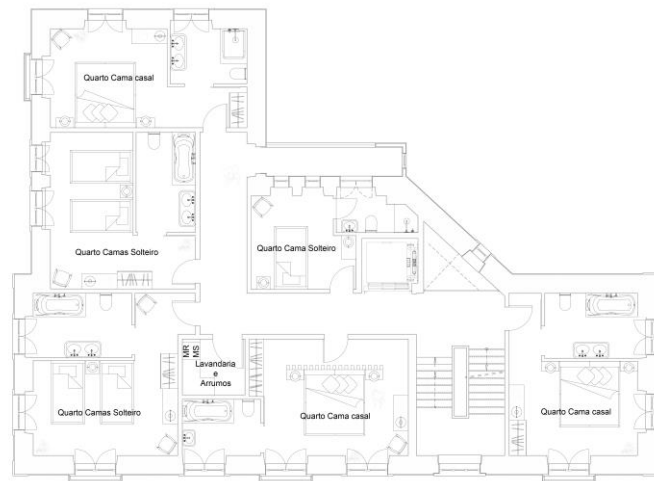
Planta de Zonamentos Piso 1. Fonte: Autor
